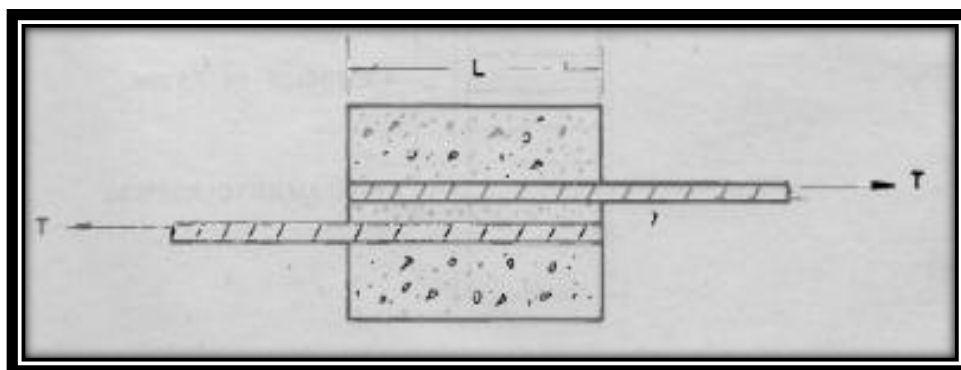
Longitud de anclaje para traslape de varillas de acero
